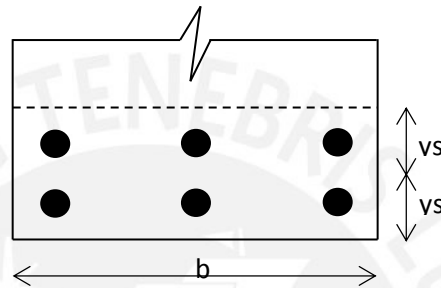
Área efectiva de concreto en tracción A_{ct} .
